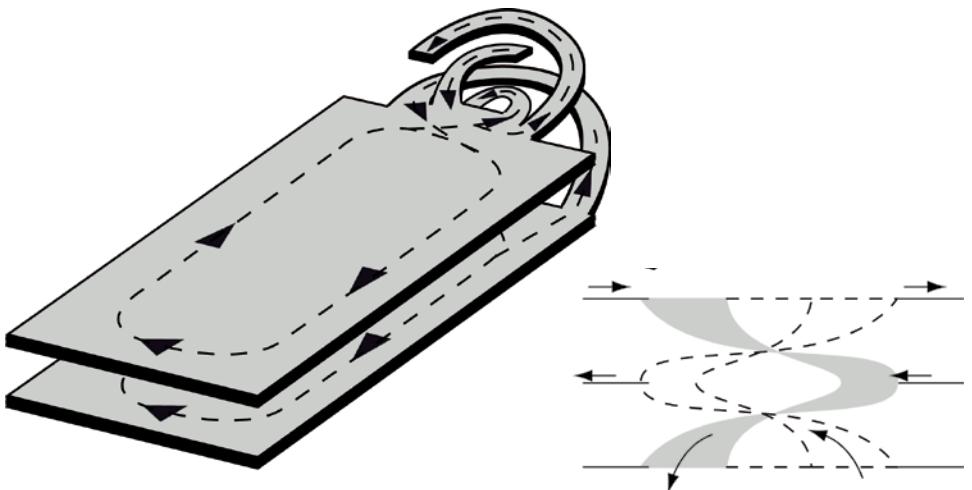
Parkhaus mit Wendelrampenanlage (Parkflächen auf den horizontalen Geschossdecken) [32]
